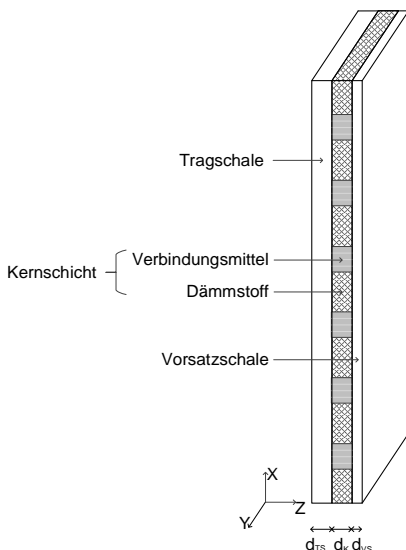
Sandwichwand mit Trag- und Vorsatzschale aus Stahlbeton
